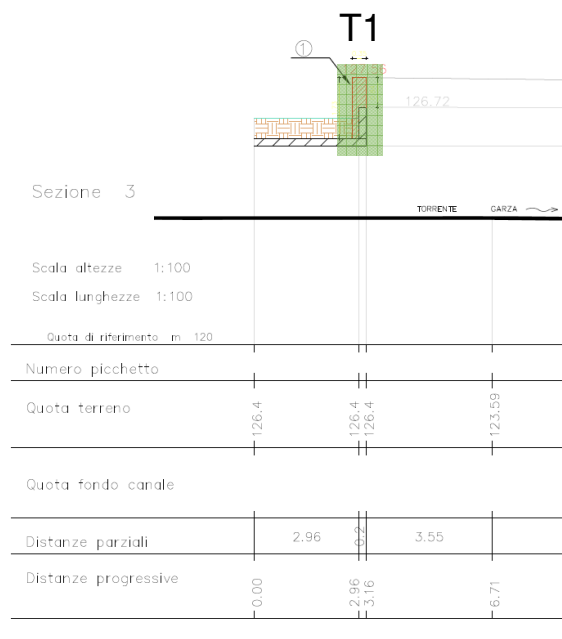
Sezione 3 di sovrapposizione (SITO 2):trave parapetto T1 (verde).
